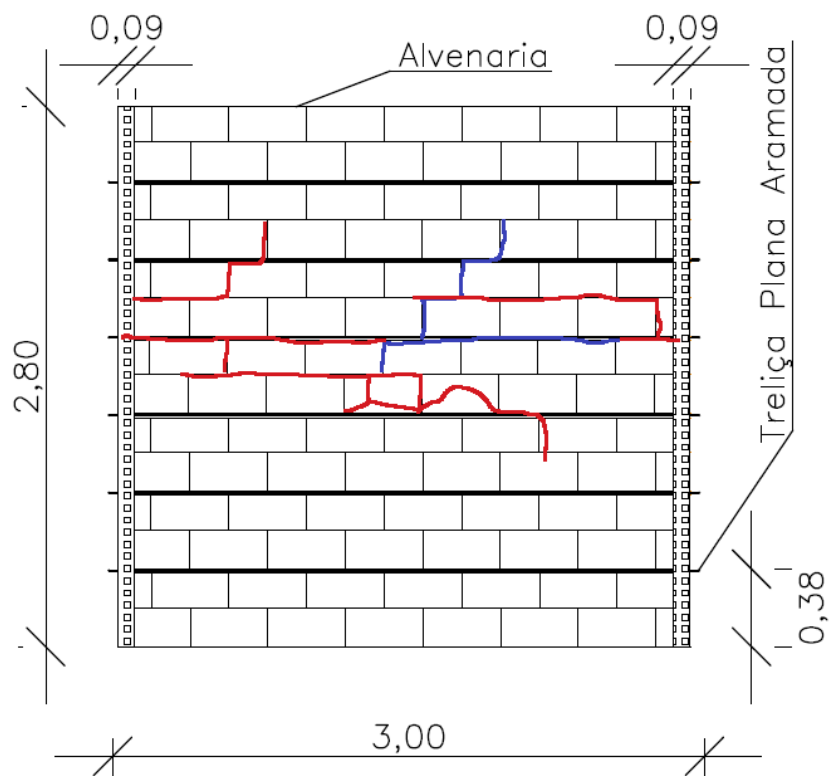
Mapeamento de fissuras da primeira alvenaria ALV – 4 (Vista frontal)
